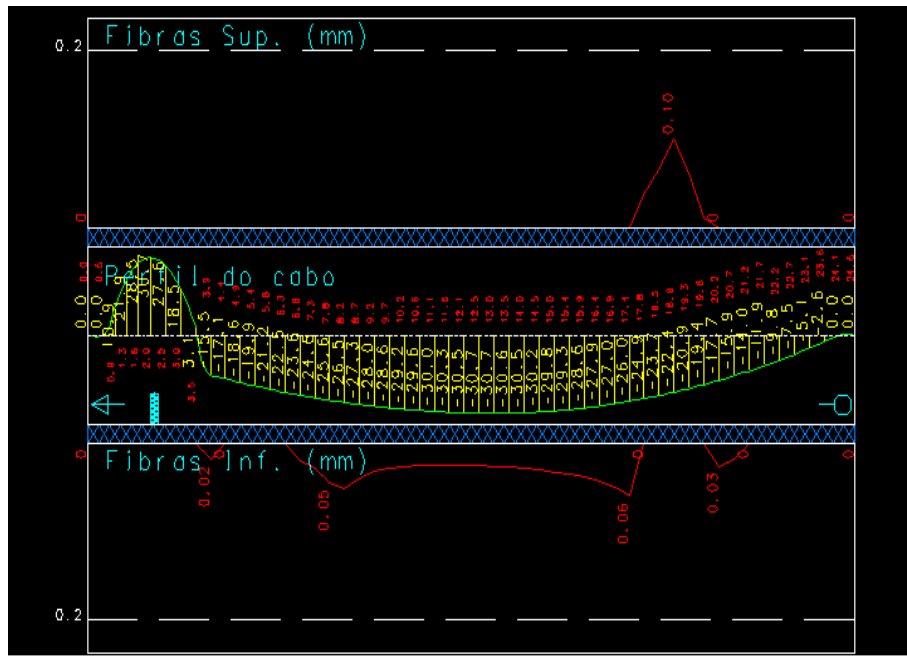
Fissuração viga V2 do 1º pavimento (CAD/TQS)
